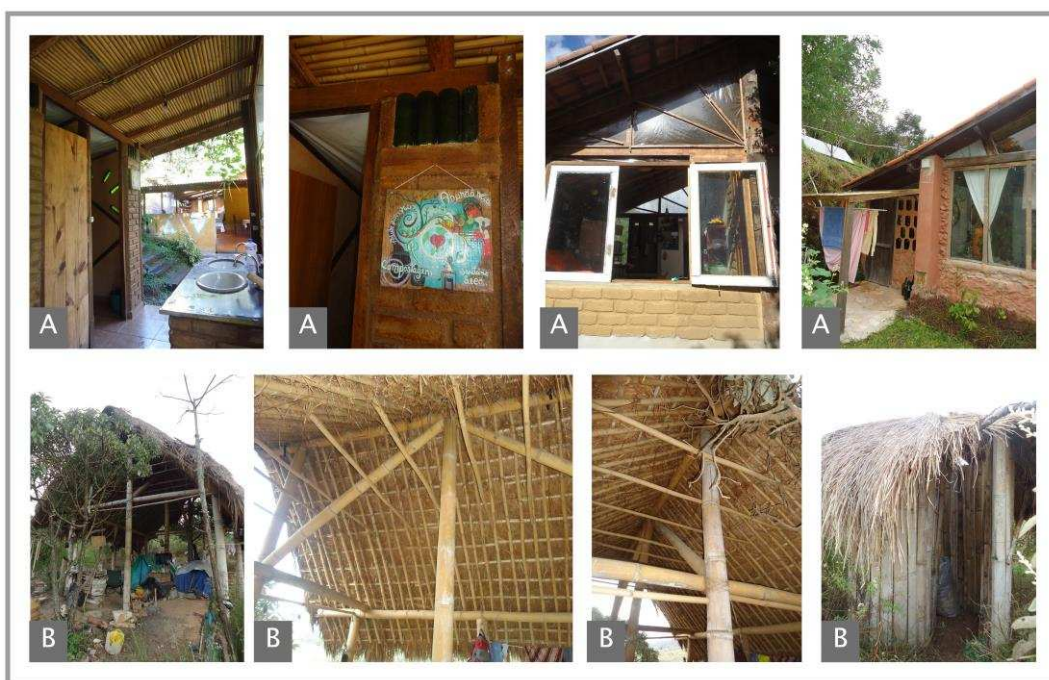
Construções com materiais naturais, reciclados e reutilizados. A – Espaços construídos em Terra Una B- Construções em bambu na ecovila São Thomé.
